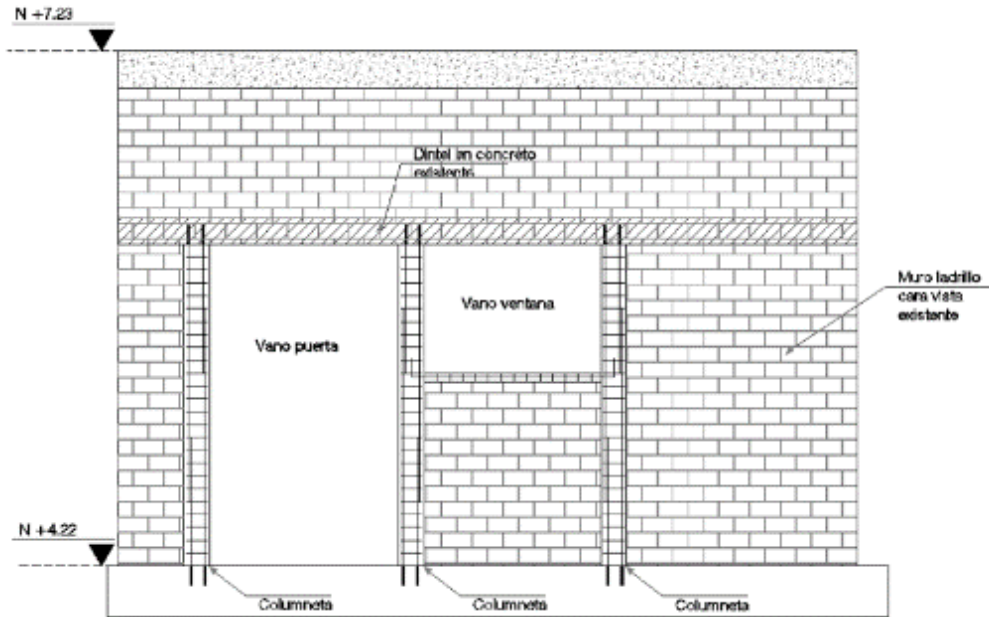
Esquema de reforzamiento por confinamiento (S. López, 2013).
